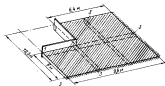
Расчетная схема slabного перекрытия на действии поперечной нагрузки.
